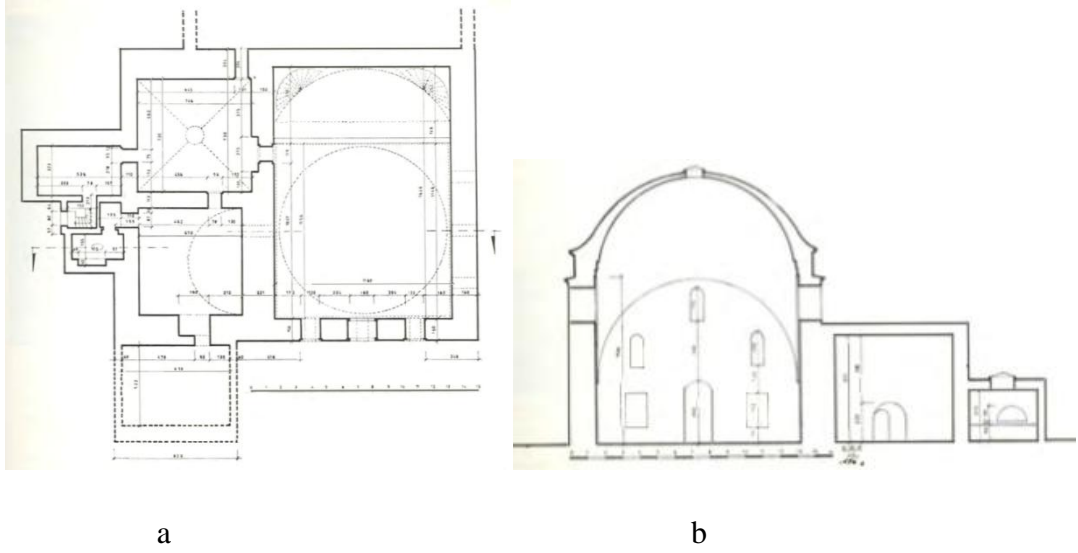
İstanbul Çemberlitaş Hamamı, planı (a), Davut Paşa Hamamı, planı (b) (Kuban,2007)
